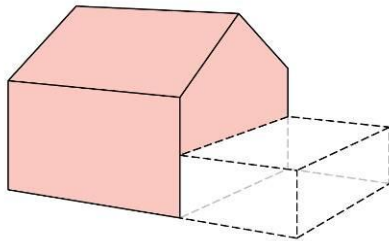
Anbau. Ein Anbau wird an eine bestehende Aussenwand hinzugefügt.
